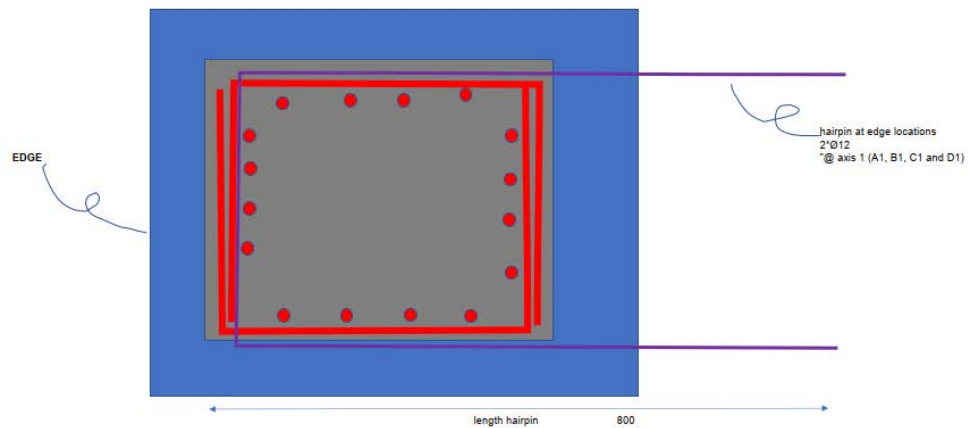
Boveenaanzicht Geometrie betonnen plaat 600mm dik
